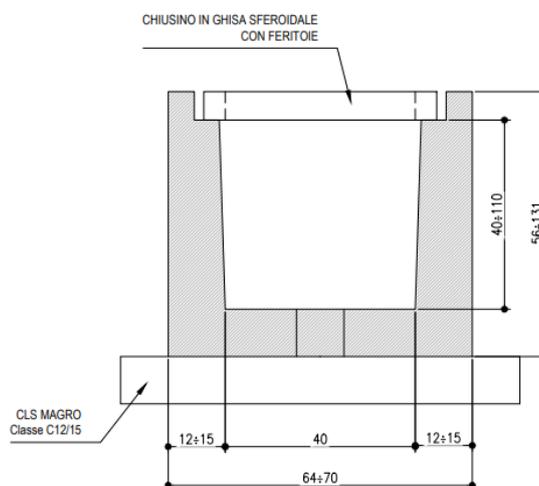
Sezione tipologica della canaletta a sezione rettangolare in cls
